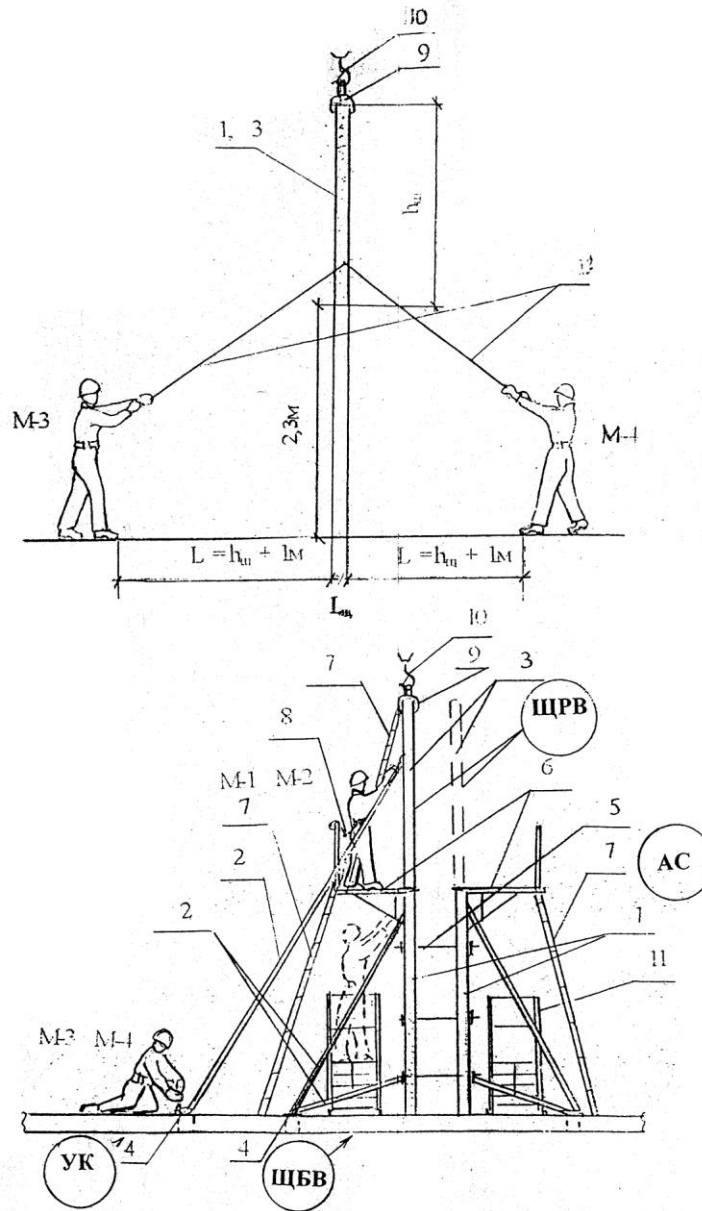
Схема транспортування і монтажу вертикальних щитів опалубки: 1 – щити 1-го ярусу; 2 – рихтовочні стояки; 3 - щити 2-го ярусу ; 4 – анкер для закріплення рихтувальних стояків; 5 – анкерні стержні з суперплитами; 6 -навісні площадки (типу Фрамакс); 7 – драбини; 8 – монтажний пояс; 9 – несуча скоба Фрамакс; 10 – захватний гак крана; 11 – монтажний столик; 12 – капронові відтяжки  $\varnothing 8\text{мм}$
